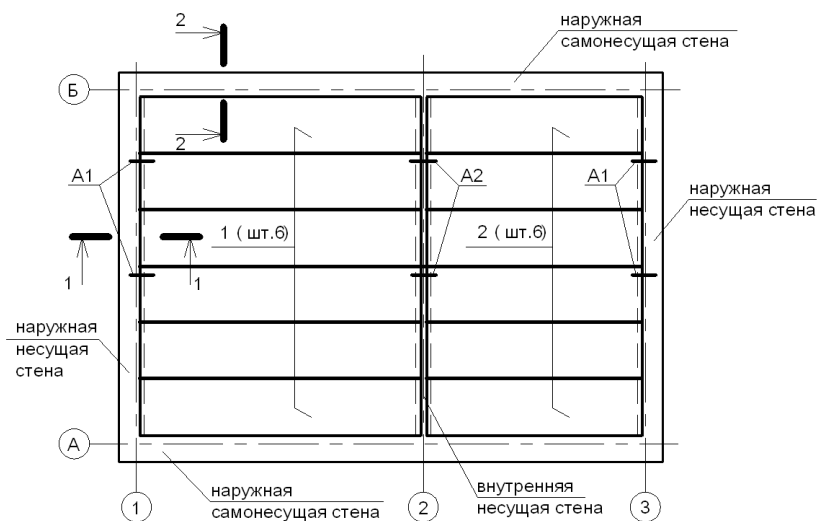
Бескаркасная система здания с поперечным расположением несущих стен
